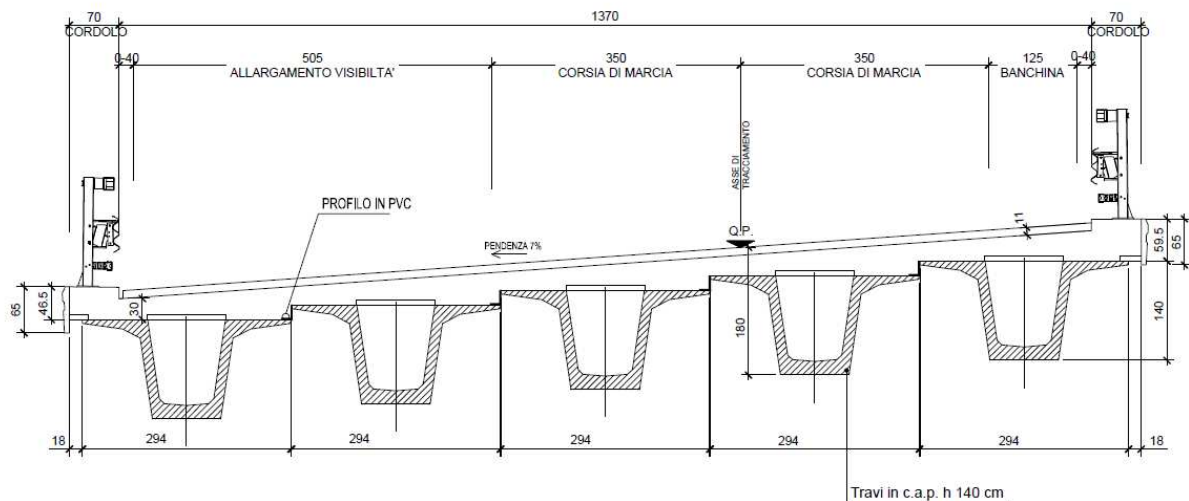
Sezione impalcato Ponte sul Condotto Generale
